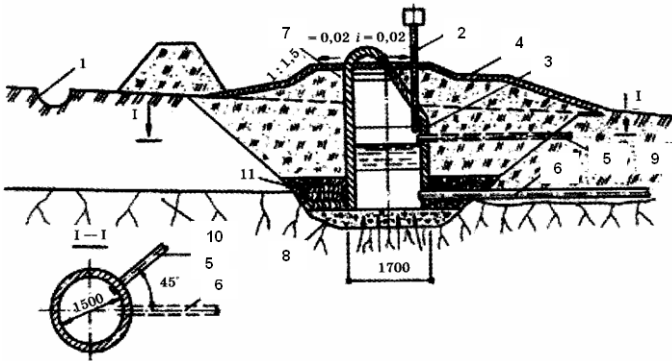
Залізобетонна каптажна камера (висхідне джерело)
